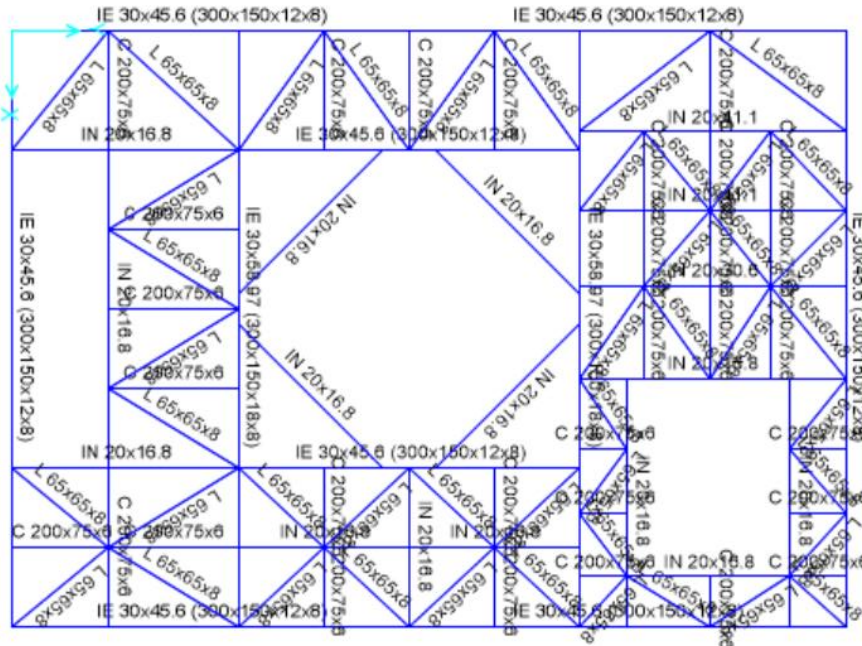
Vista en planta elevación 8.4 [m] sobre nivel de terreno.
